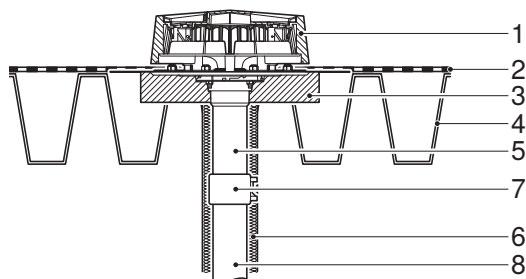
Montage dans toiture en bac d'acier non isolée avec revêtement d'étanchéité
